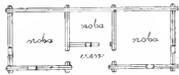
Grundriss des Hauses Nr. 336 in Uzon (1:400).
